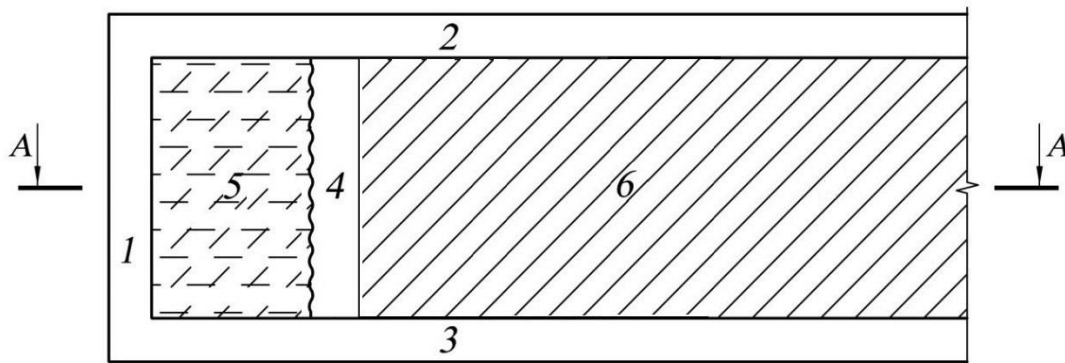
Расчетная схема к решению задачи: 1 – монтажная камера; 2 – вентиляционный штрек; 3 – откаточный штрек; 4 – очистной забой; 5 – выработанное пространство лавы; 6 – угольный пласт.
